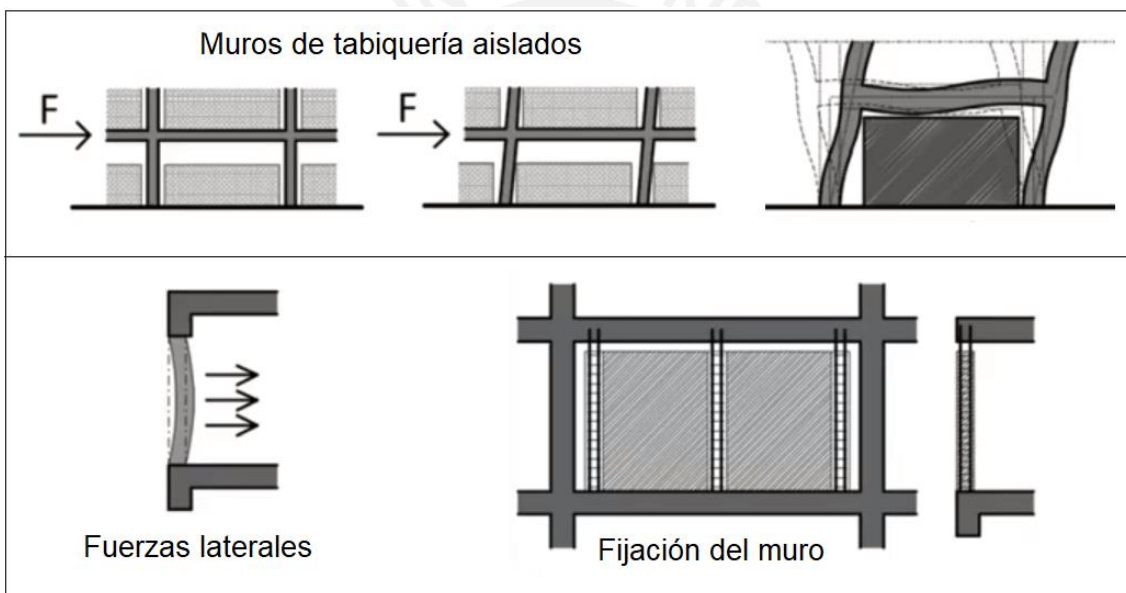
Fijación de muro a columnetas. " MOOC SISMO 6.5 Elementos no estructurales – Universidad Politécnica de Madrid"
